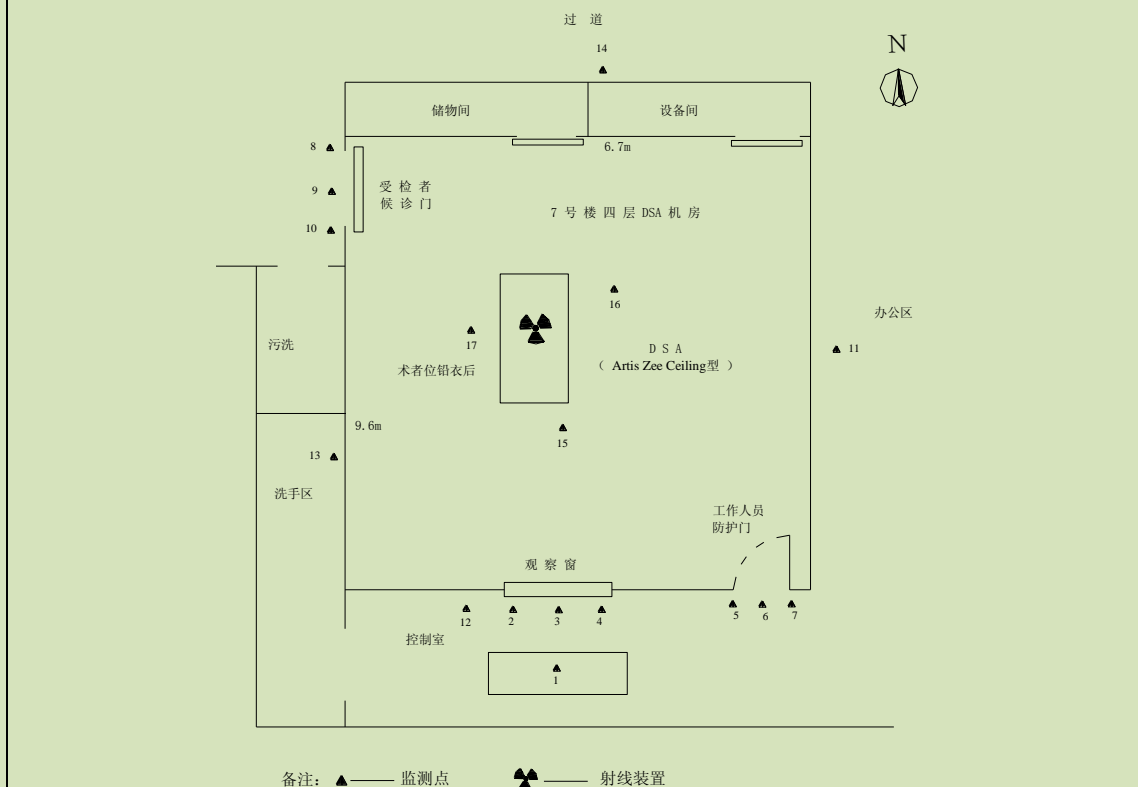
本部 7 号楼四层 DSA 机房现场监测点平面图
